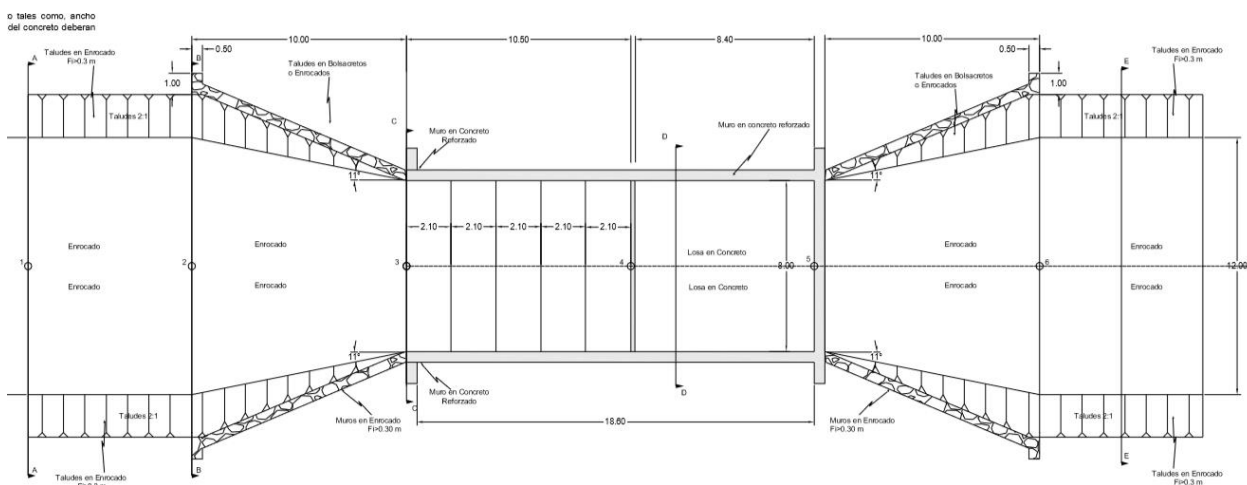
Vista en planta de la estructura de disipación de energía del Caño Piedras
